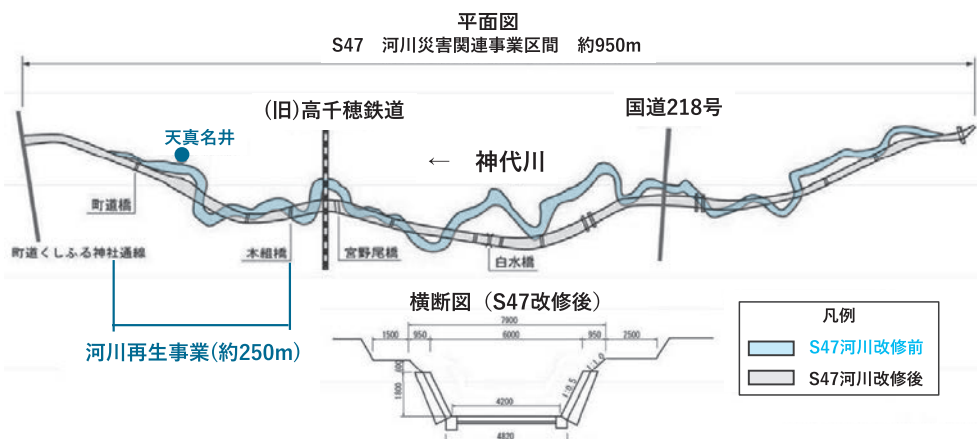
河川改修前後の平面図及び改修後横断面図（昭和47年）
